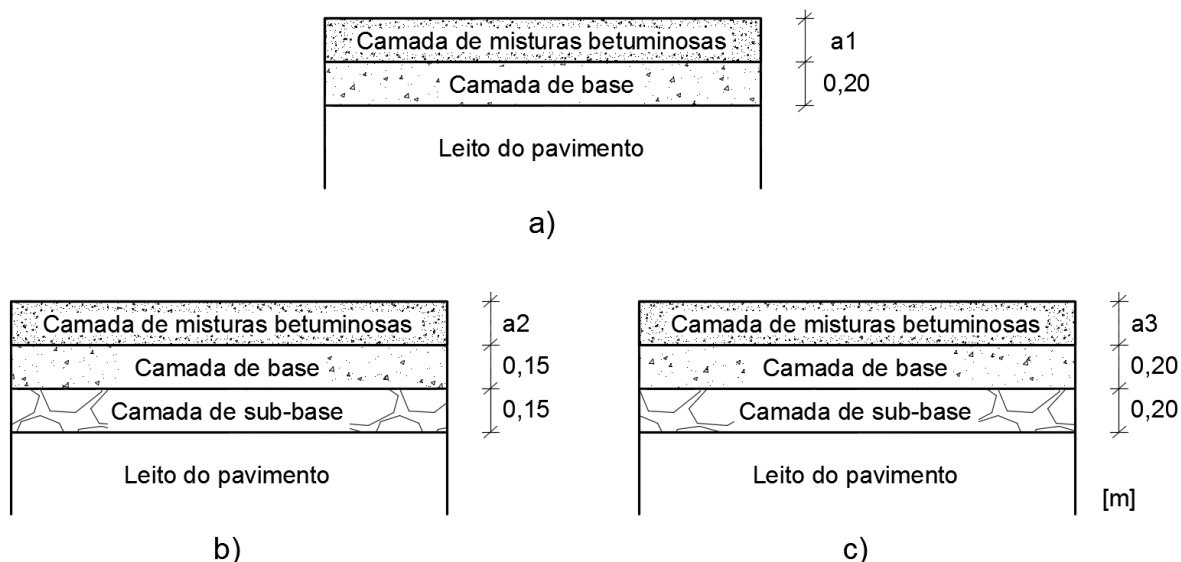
Tipos de pavimento base considerados: a) Pavimento tipo 1; b) Pavimento tipo 2; e c) Pavimento tipo 3.
